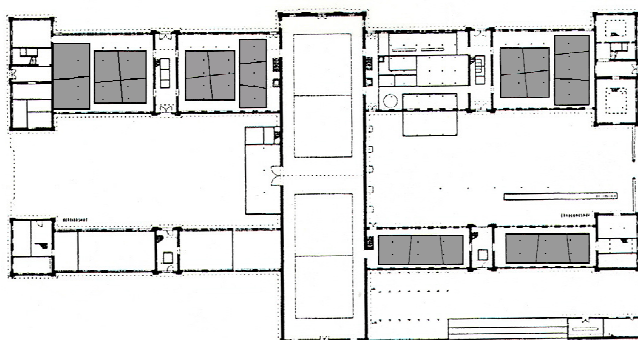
Grundriss des Kasernengebäudes.
